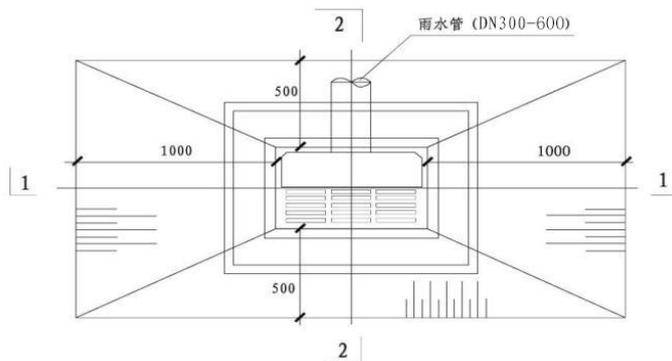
雨水管及雨水口平面图（单位：mm）
